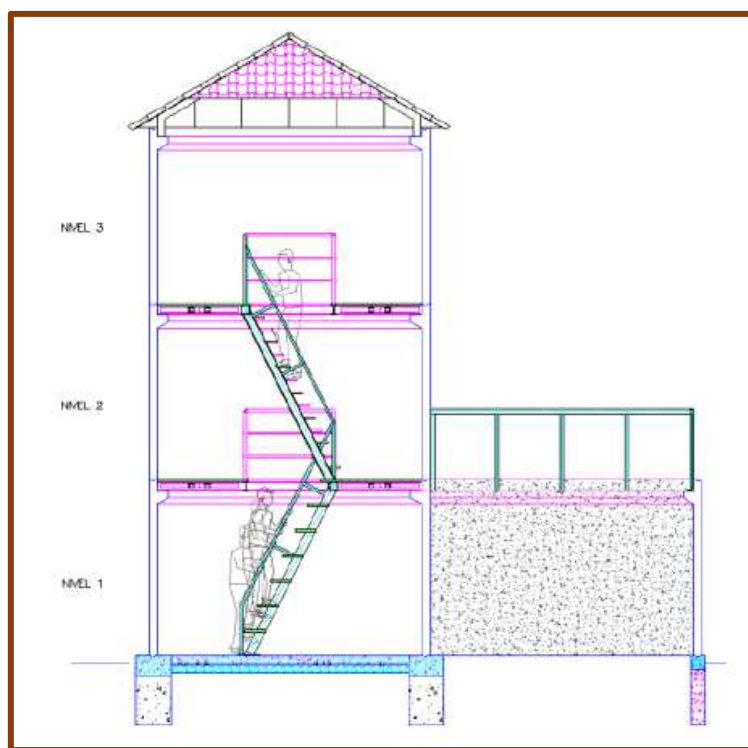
Propuesta de diseño para la construcción de un primillar interior. Fuente: GREFA
